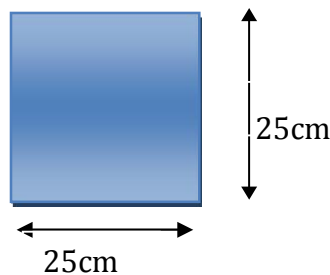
Coupe transversal de la poutre de chaînage.
